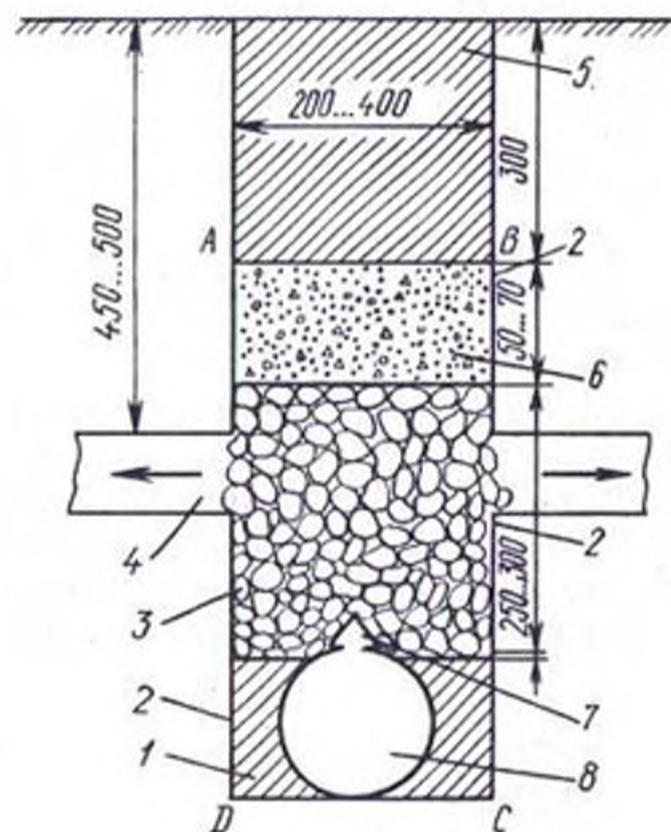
Поперечный разрез траншеи оросительного трубопровода с пористой засыпкой:
